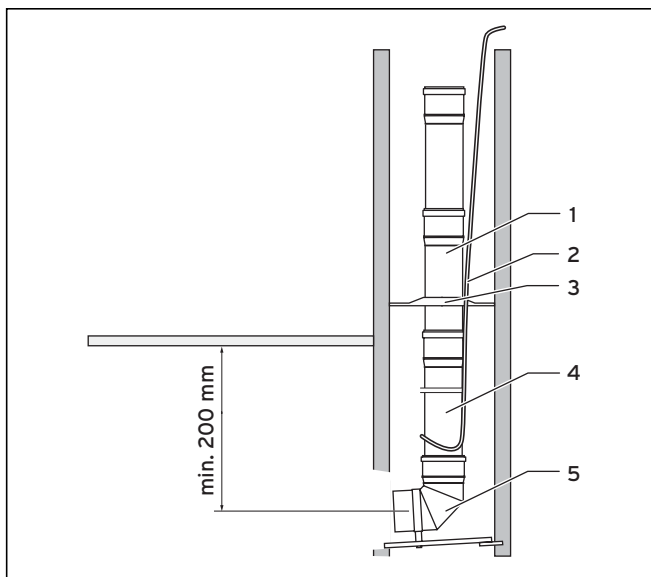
Монтаж опорного колена и установка труб газоотвода в шахте
